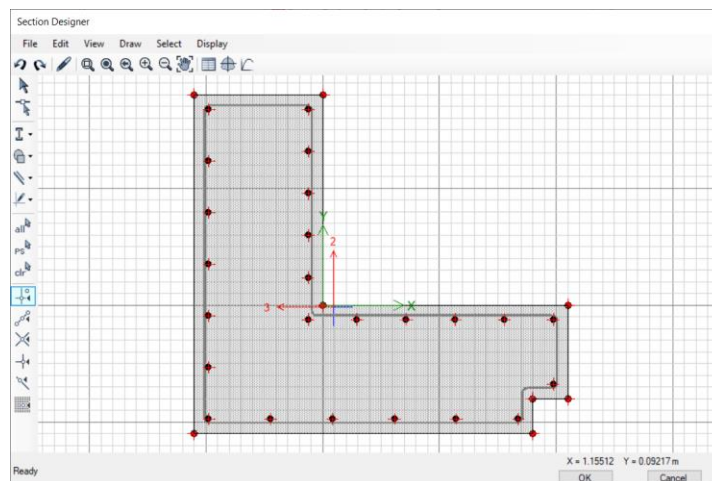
Definición de las propiedades de las rotulas tipo fibra.
